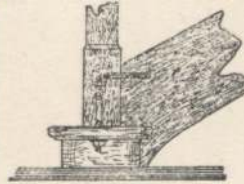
Der mit einer Schraube und einem Dübel befestigte Antrittspfosten.
